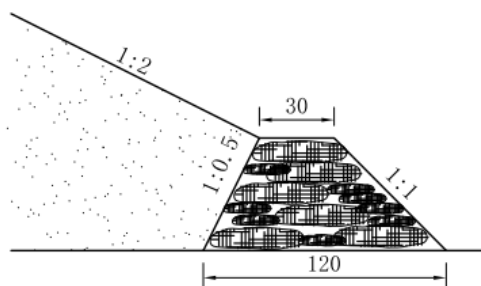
临时拦挡典型断面图（单位：mm）
